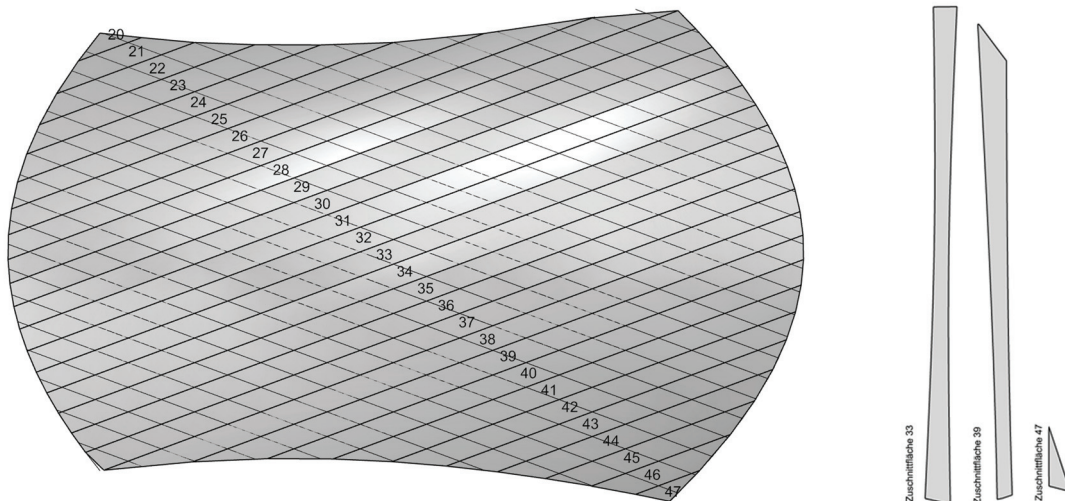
Screenhaus.SOLAR — Bemessungsvariante Nr. 2, Zuschnittflächen
